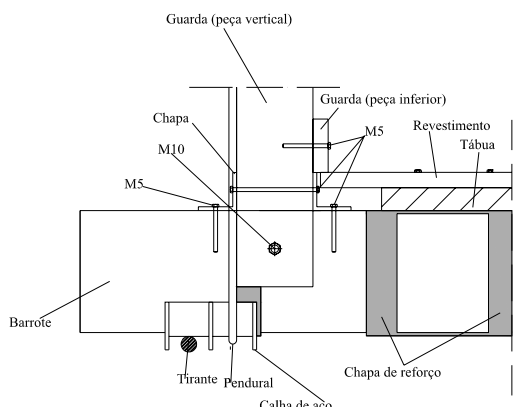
Pormenor da zona de passagem dos tirantes sob o pavimento (secção transversal).
